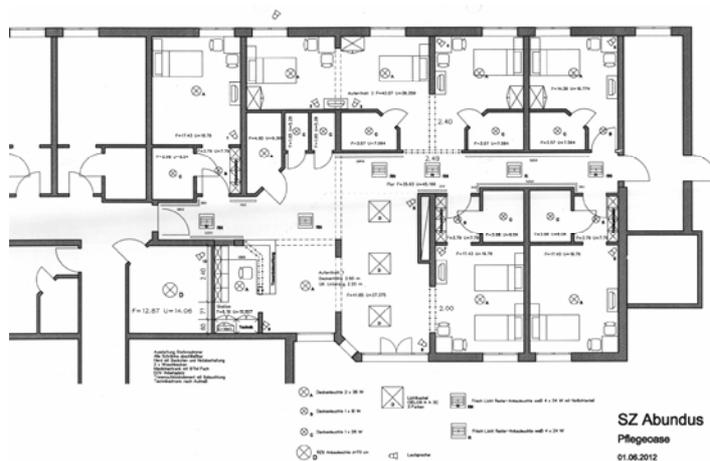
Grundriss Tagespflegeoase mit anschließenden Zimmern
